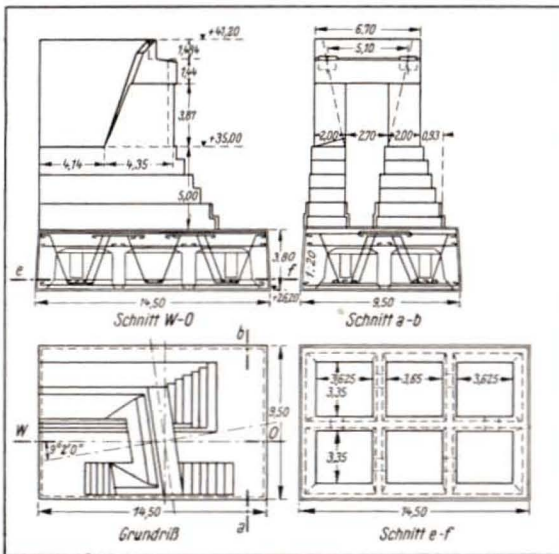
Ringbahnkreuzung: Westwiderlager, Schnitte, Grundrisse
